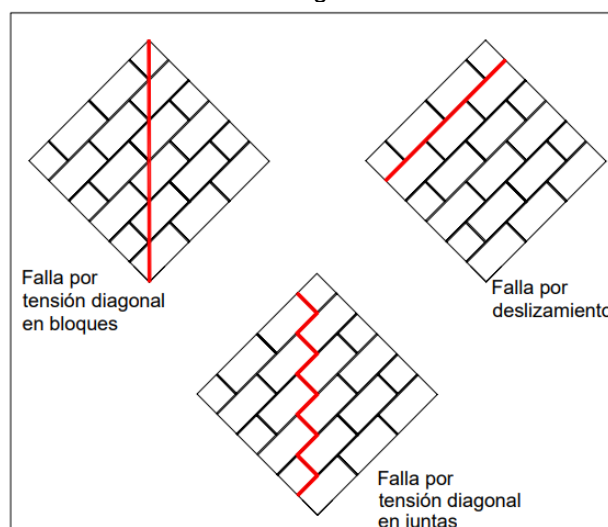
Tipos de falla en murete de mampostería en compresión diagonal
